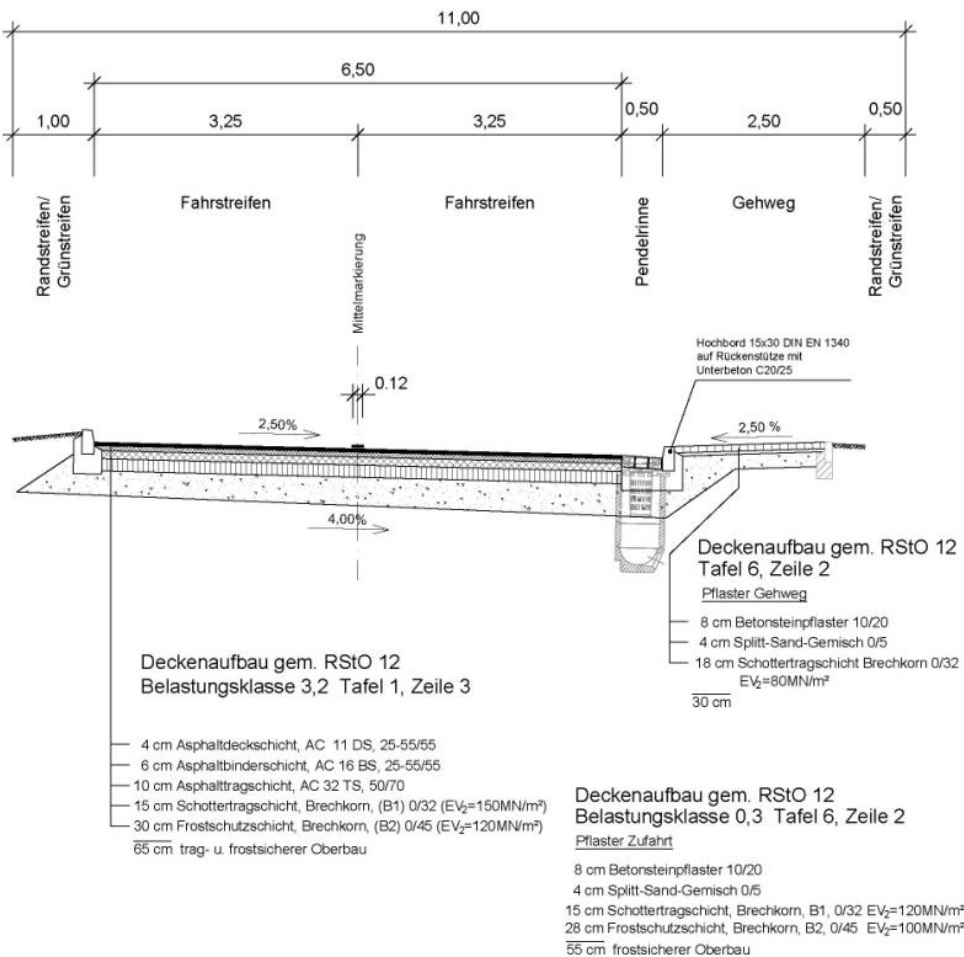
Querschnitt Erschließungsstraße – Vorzugsvariante
